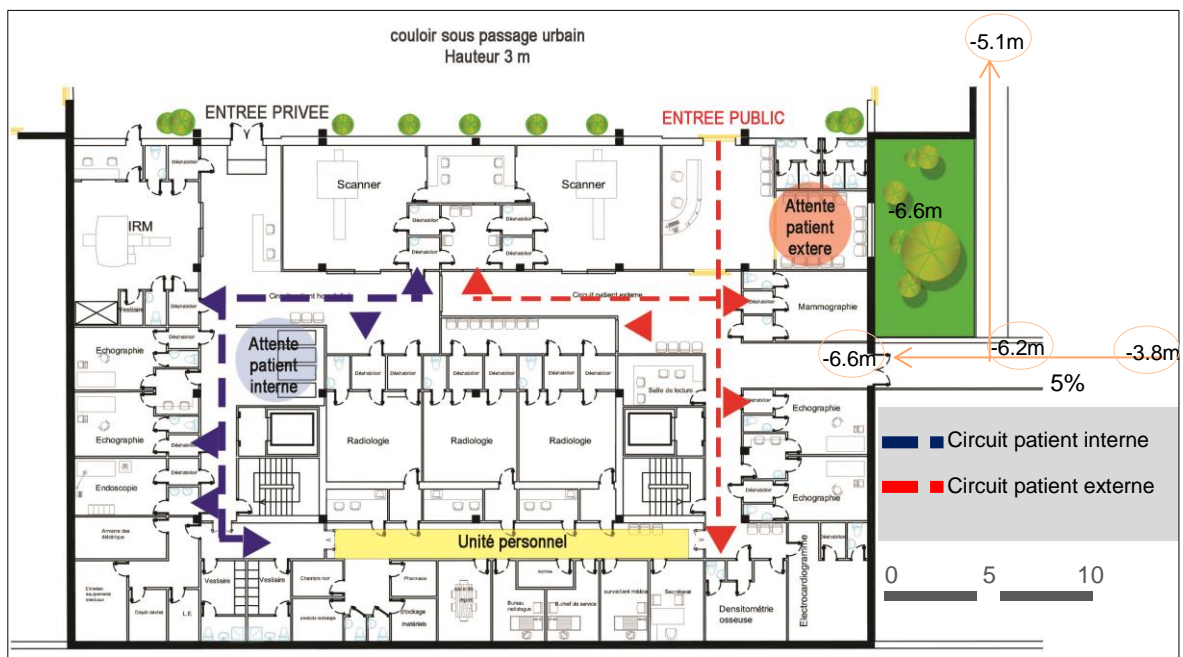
Plan architectural du service d'IMAGERIE MEDICALE, Niveau -6.6 m
